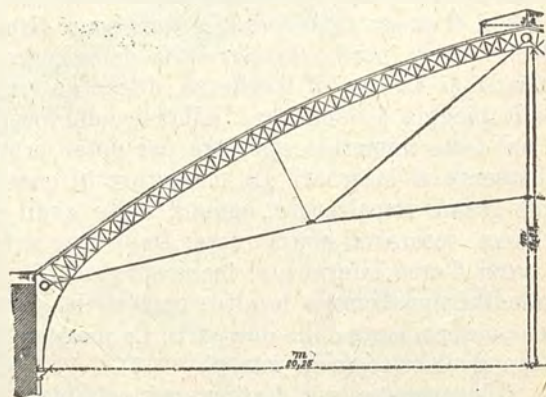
Tettoia della Stazione Centrale di Milano.
